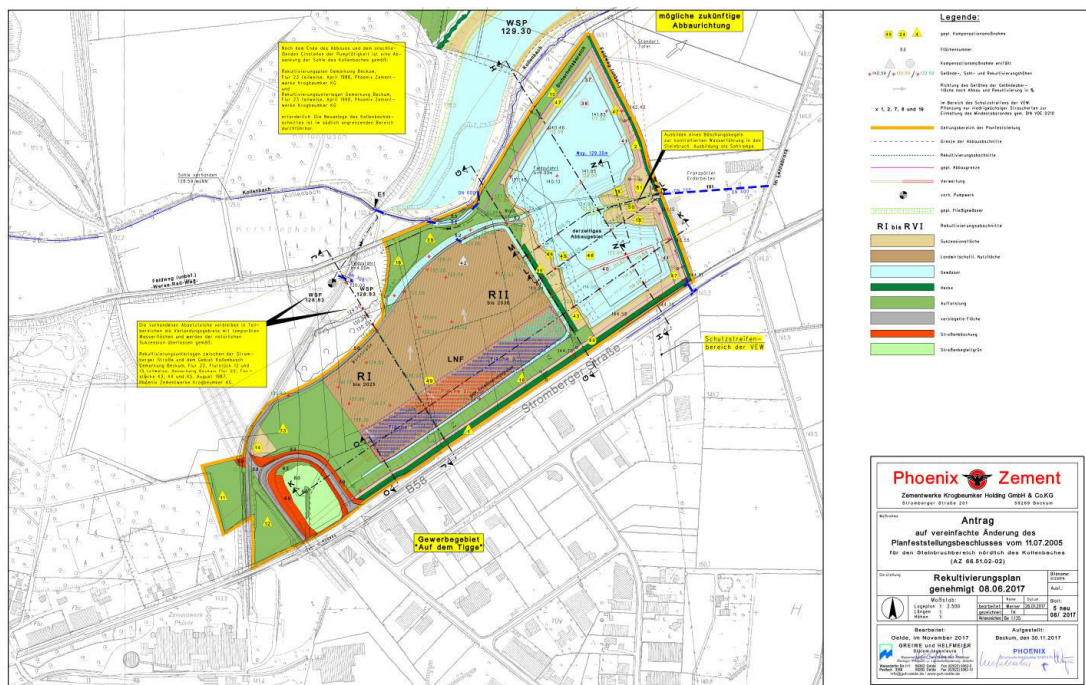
Rekultivierungsplan mit PV-Anlage, Entwurfsstand: November 2017
